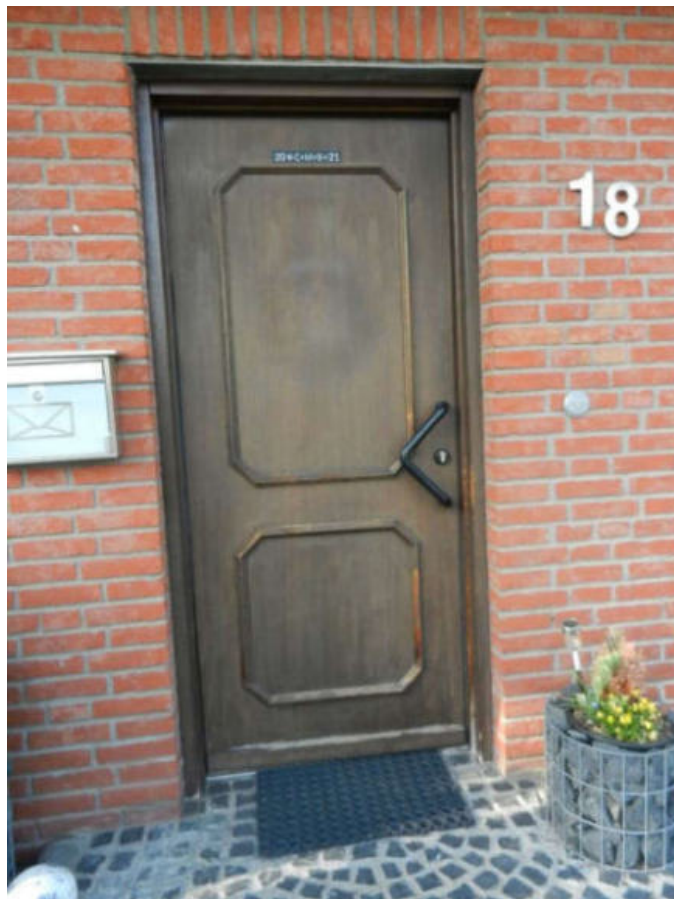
Sehr einfache Haustür aus Holz mit Abblätterungen der Beschichtung
